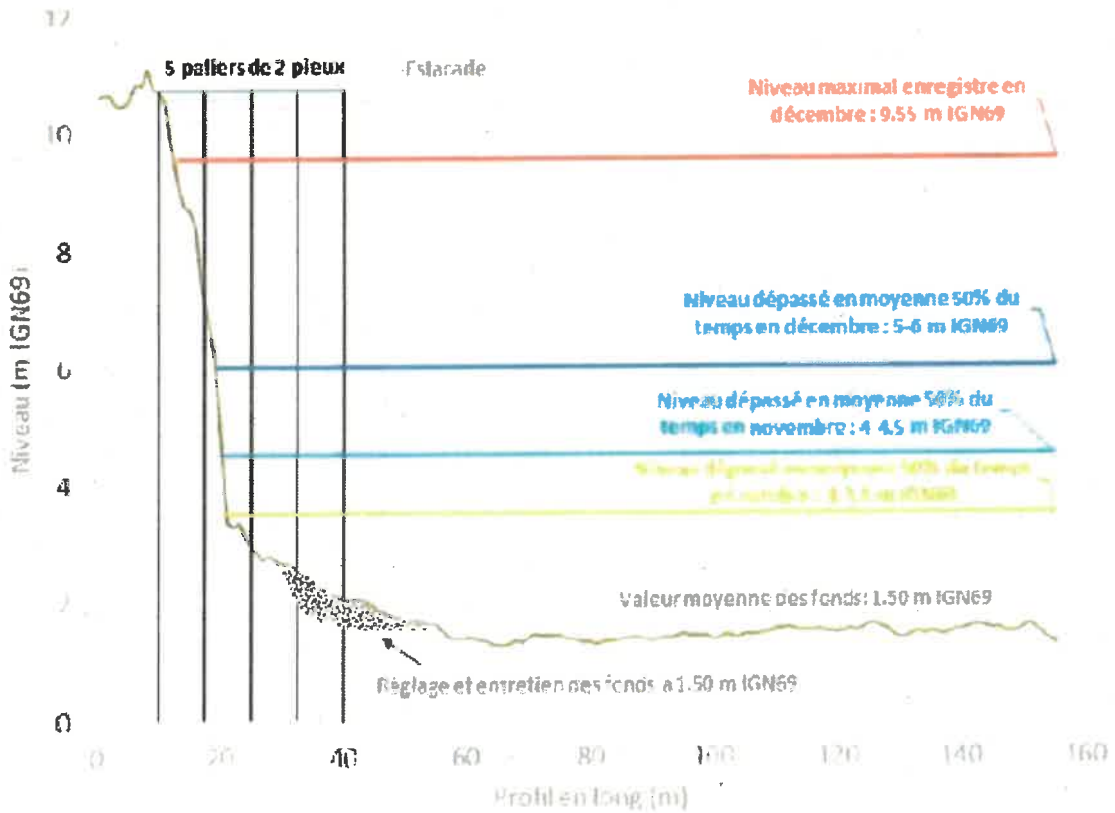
COUPE LONGITUDINALE DE L'ESTACADE
